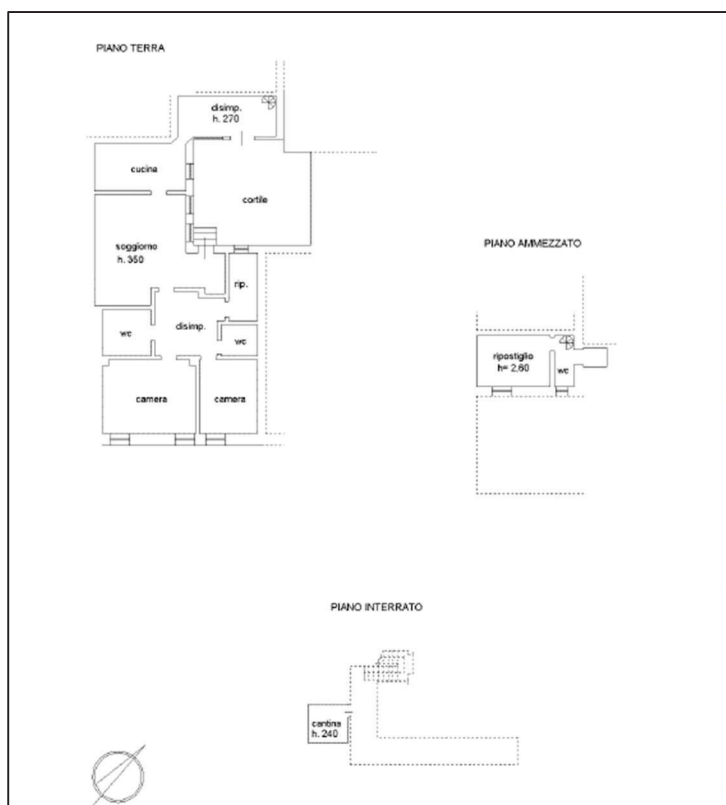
planimetria catastale vigente prima della variazione operata dallo scrivente per esatta rappresentazione dei luoghi
